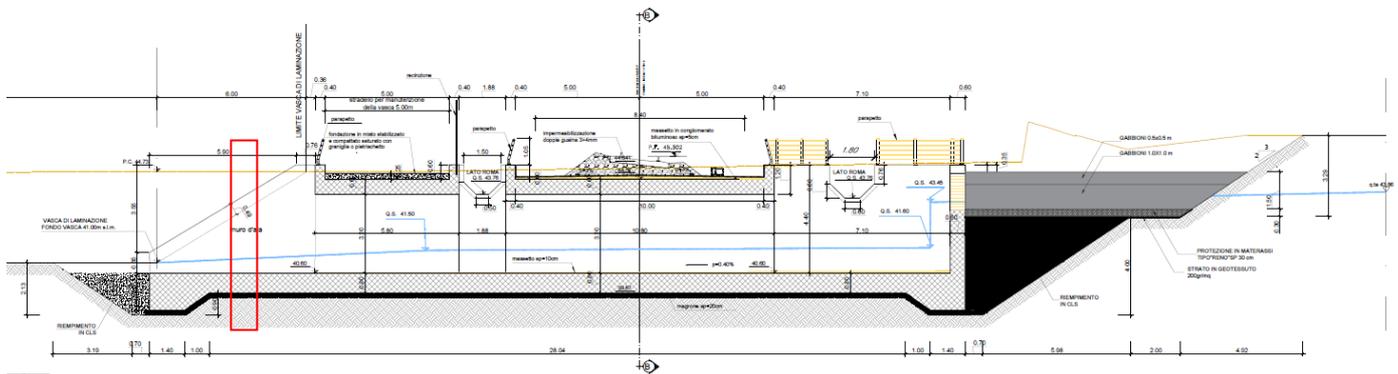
Sezione longitudinale e individuazione delle sezioni SC2 oggetto di verifica.
